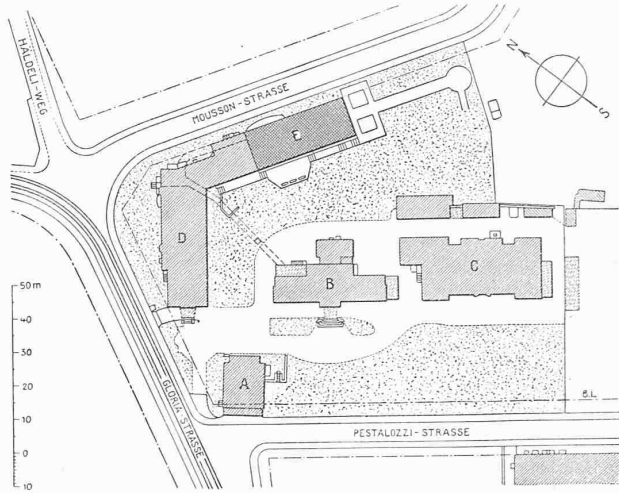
Lageplan 1:2000. — A Altes Haus; B 1887 erbaut; C 1900; D 1914; E 1926 erbaut.
